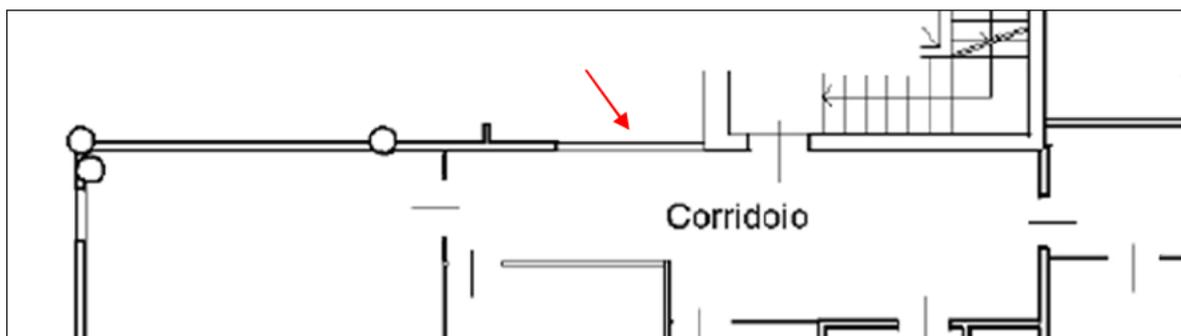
estratto della planimetria catastale dell'ufficio particella 34 sub 40
